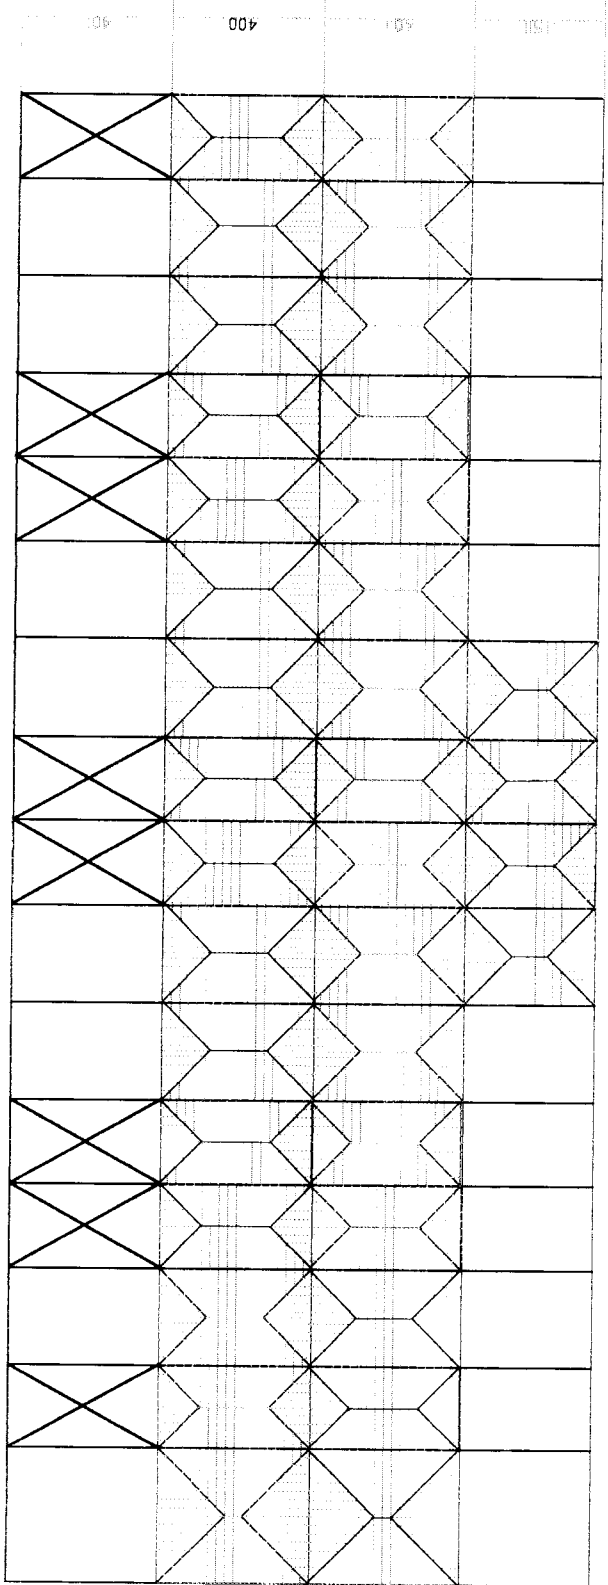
Rencana Penulangan Balok Anak Lantai Atap
